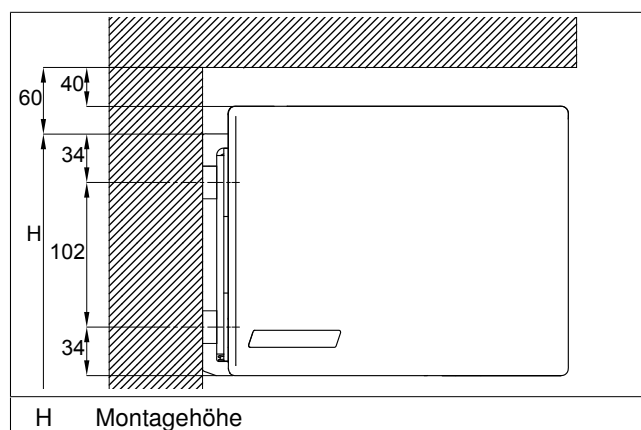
notwendiger Montagebereich nach oben bei Überdachungen (alle Maßangaben in mm)
